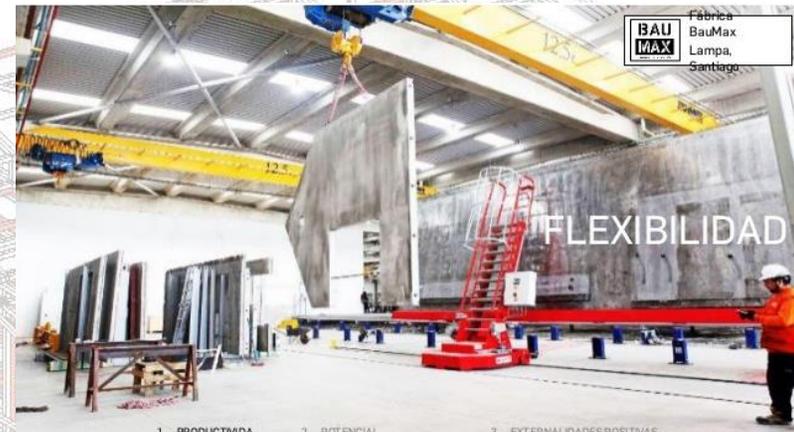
Planta robotizada en la elaboración de prefabricado hormigón BAUMAX. Fuente página web BAUMAX.
